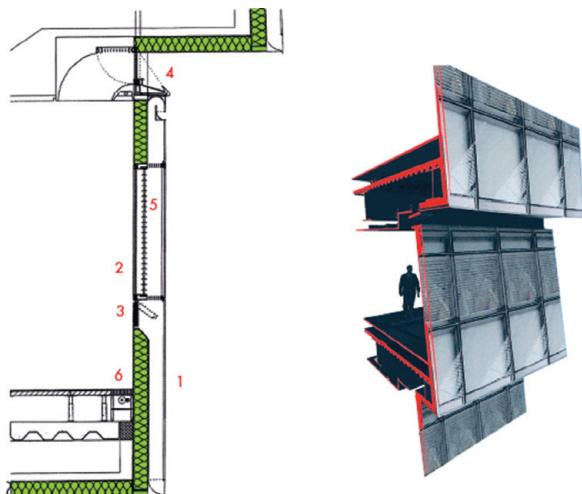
Схема конструкції південного фасаду будівлі мерії Лондону:
